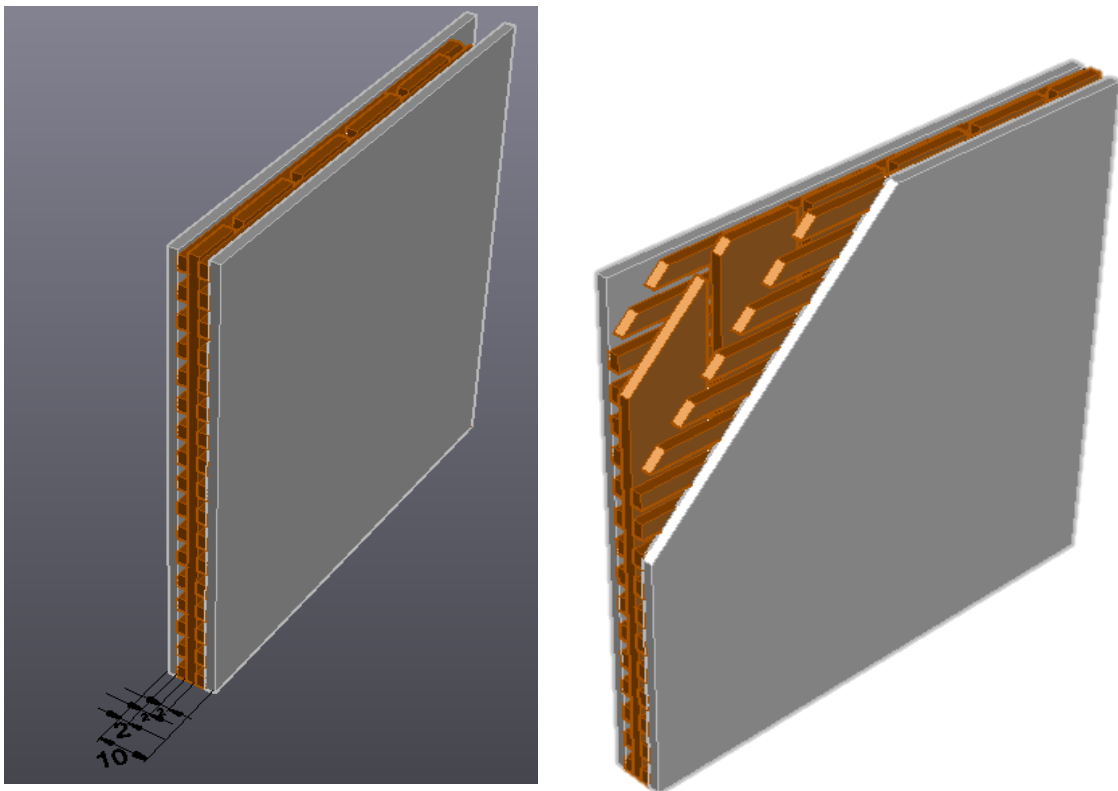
Paredes interiores, pormenor do tabique, medidas em cm e corte para ver o interior
